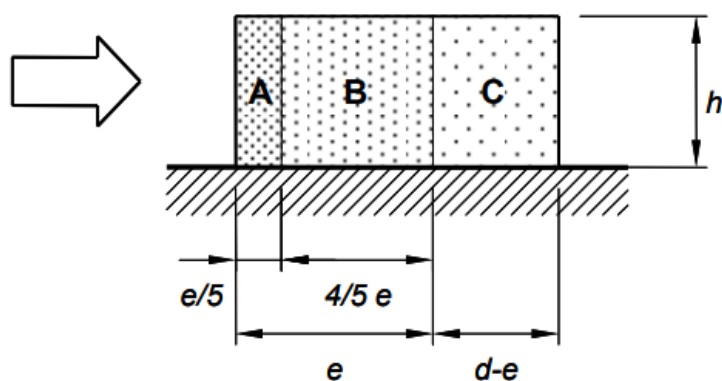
9: Suddivisione delle pareti verticali di edifici a pianta rettangolare in zone di uguale pressione (prospetto).
